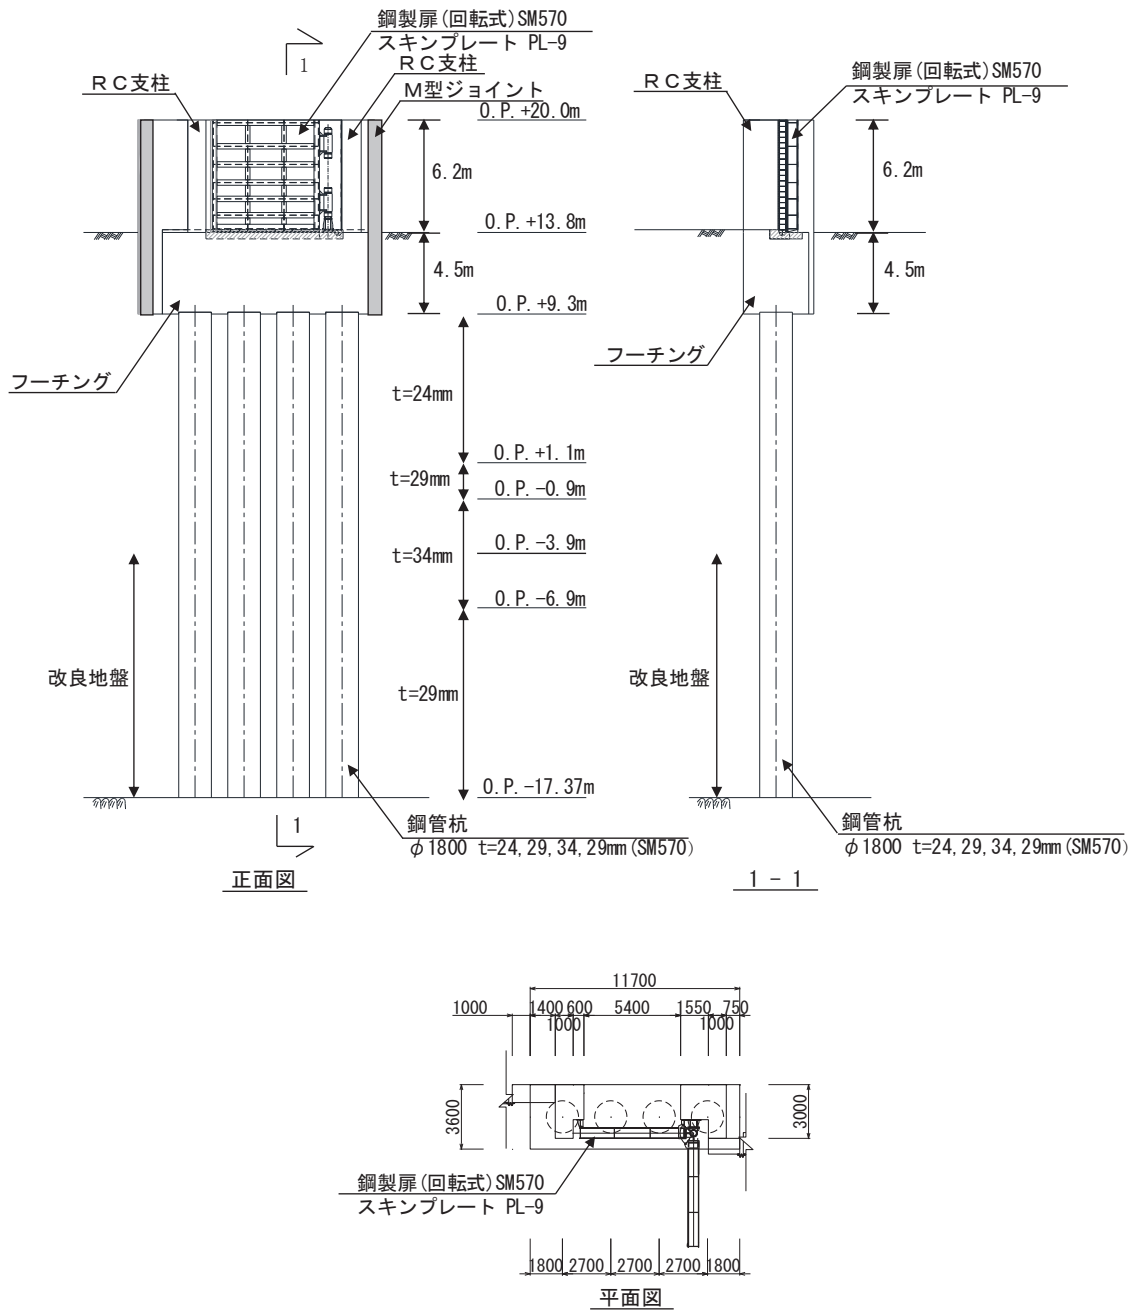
(1) 鋼製扉 3 の構造図 (正面図及び断面図, 平面図)
